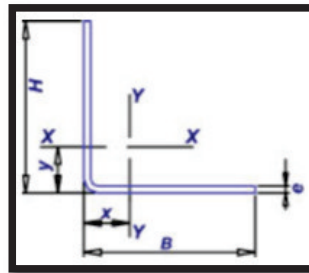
Tipo de perfil longitudinal del tablero del puente
